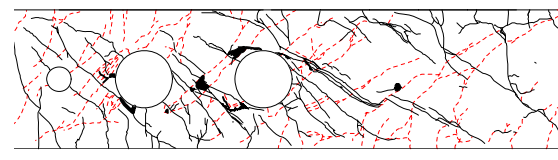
実験のひび割れ状況 (S-1,R=1/100)
